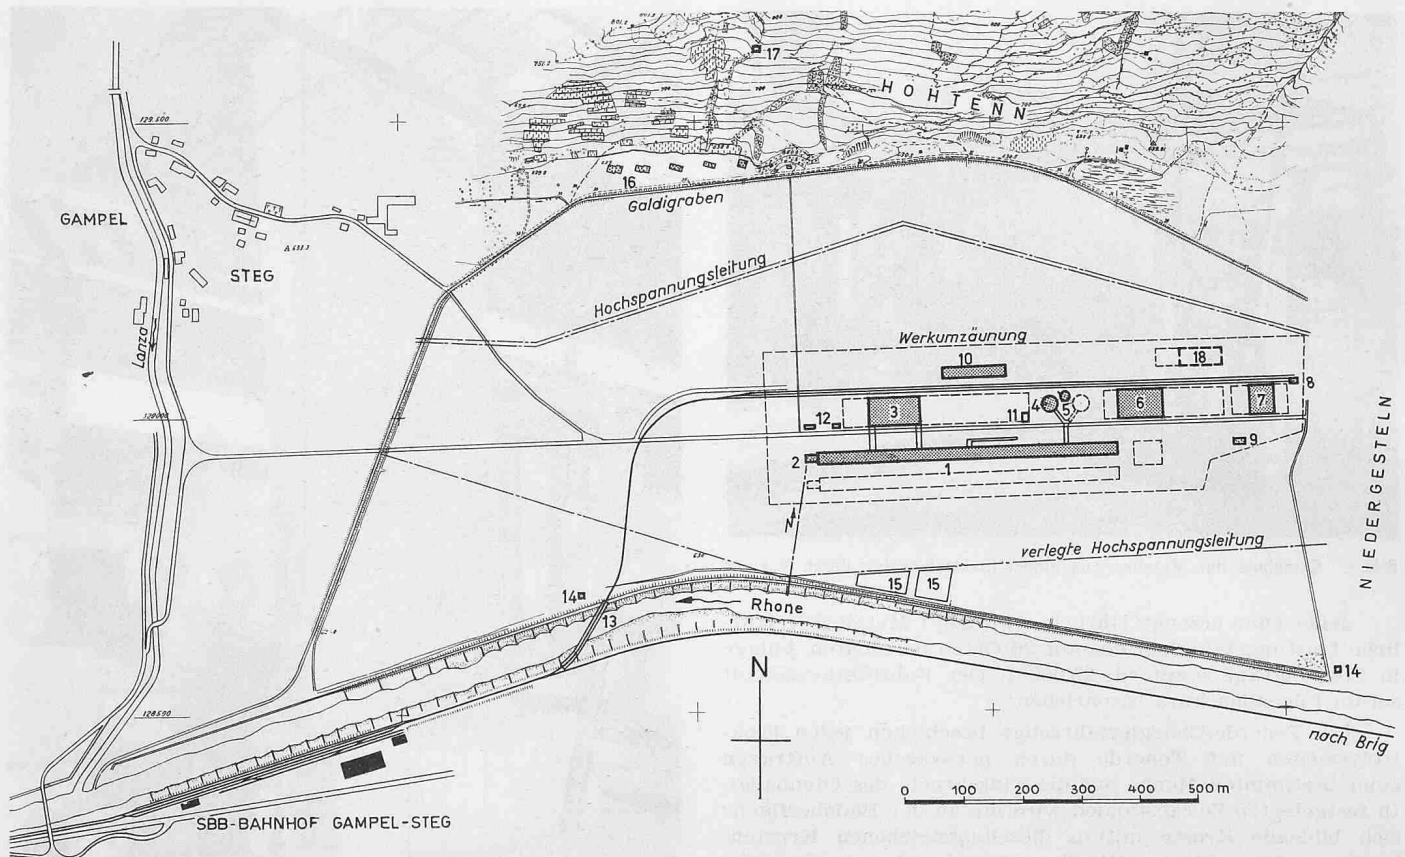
Lageplan der Hütte Steg, Masstab 1:13 000
